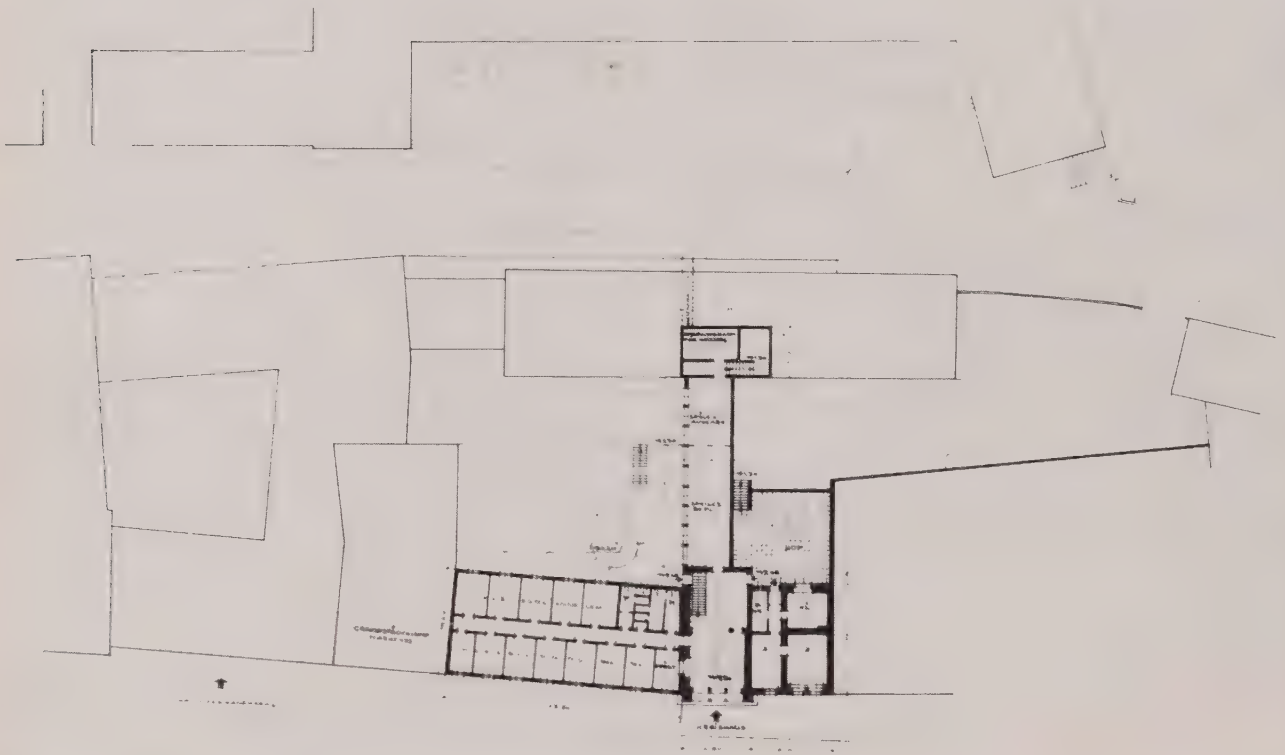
Erdgeschoß des Gebäudes der Kreisverwaltung (Grundprojekt)
